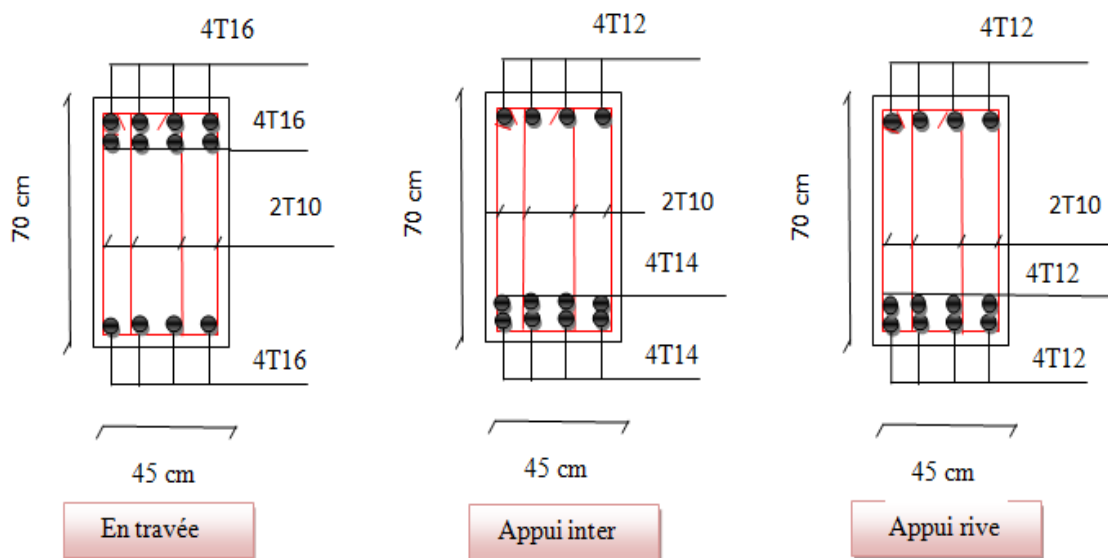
Ferrailage de la poutre de libage suivant le sens transversale.
